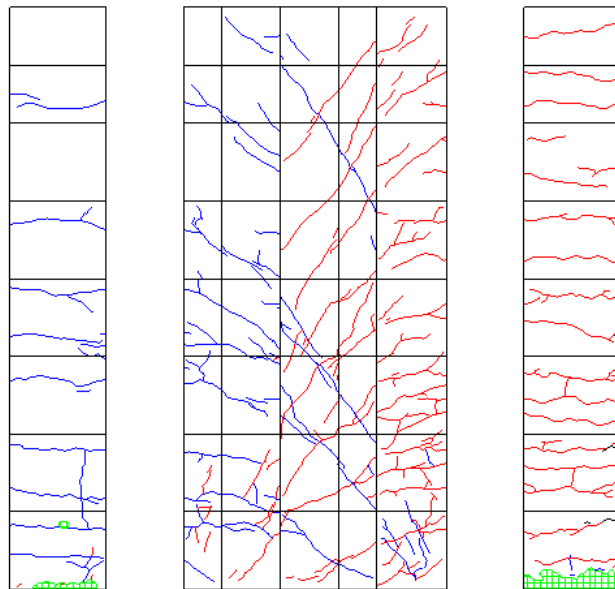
R=-1/33 ひび割れ図
